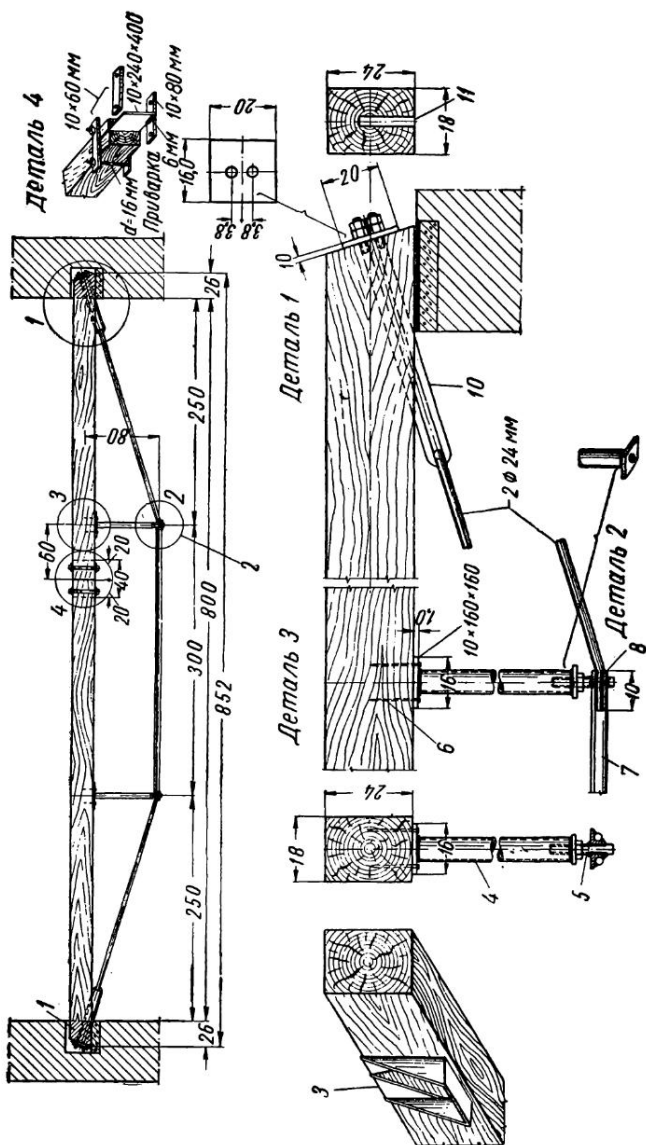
Шпренгельные поперечные прогоны, скрытые в толще перегородки, с верхним деревянным поясом и металлической затяжкой:
